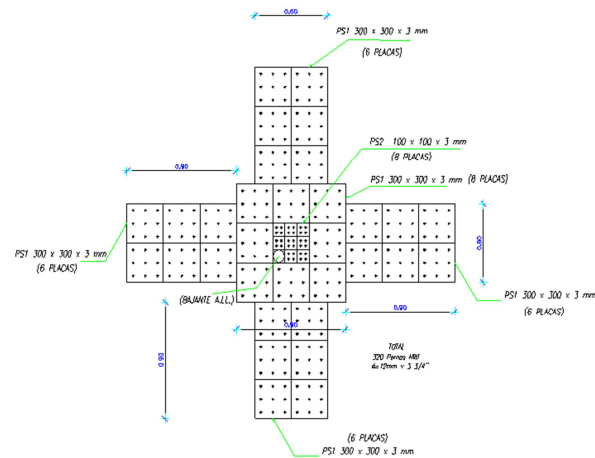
Detalle en planta de las placas colocadas en Paraboloides
